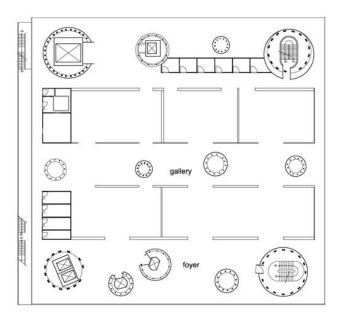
Planta 5to. Nivel, Mediateca de Sendai.
